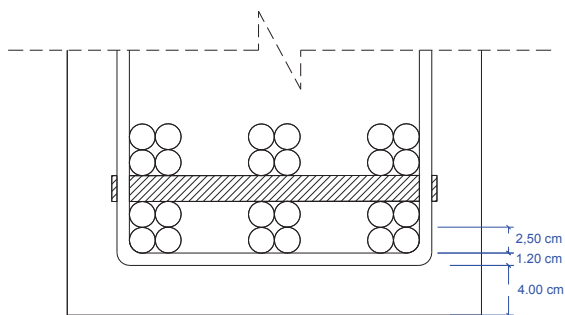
Esquema de armado acero principal de la viga interior.
